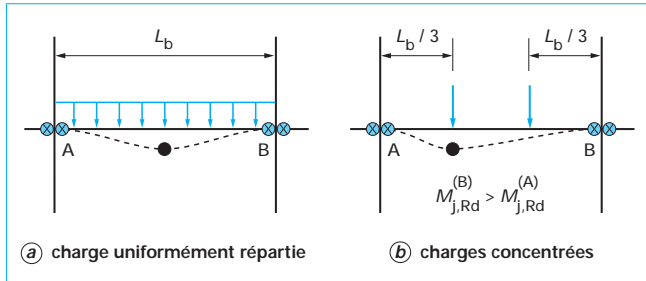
Mécanismes plastiques de poutre dans les ossatures semi-continues et contreventées
